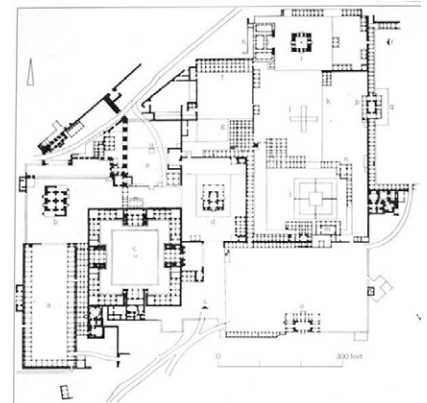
Planta de la ciudad Fatehpur Sikri, Uttar Pradesh.
